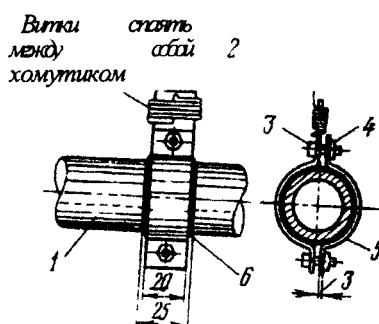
Подключение заземляющего провода к водопроводной трубе:
